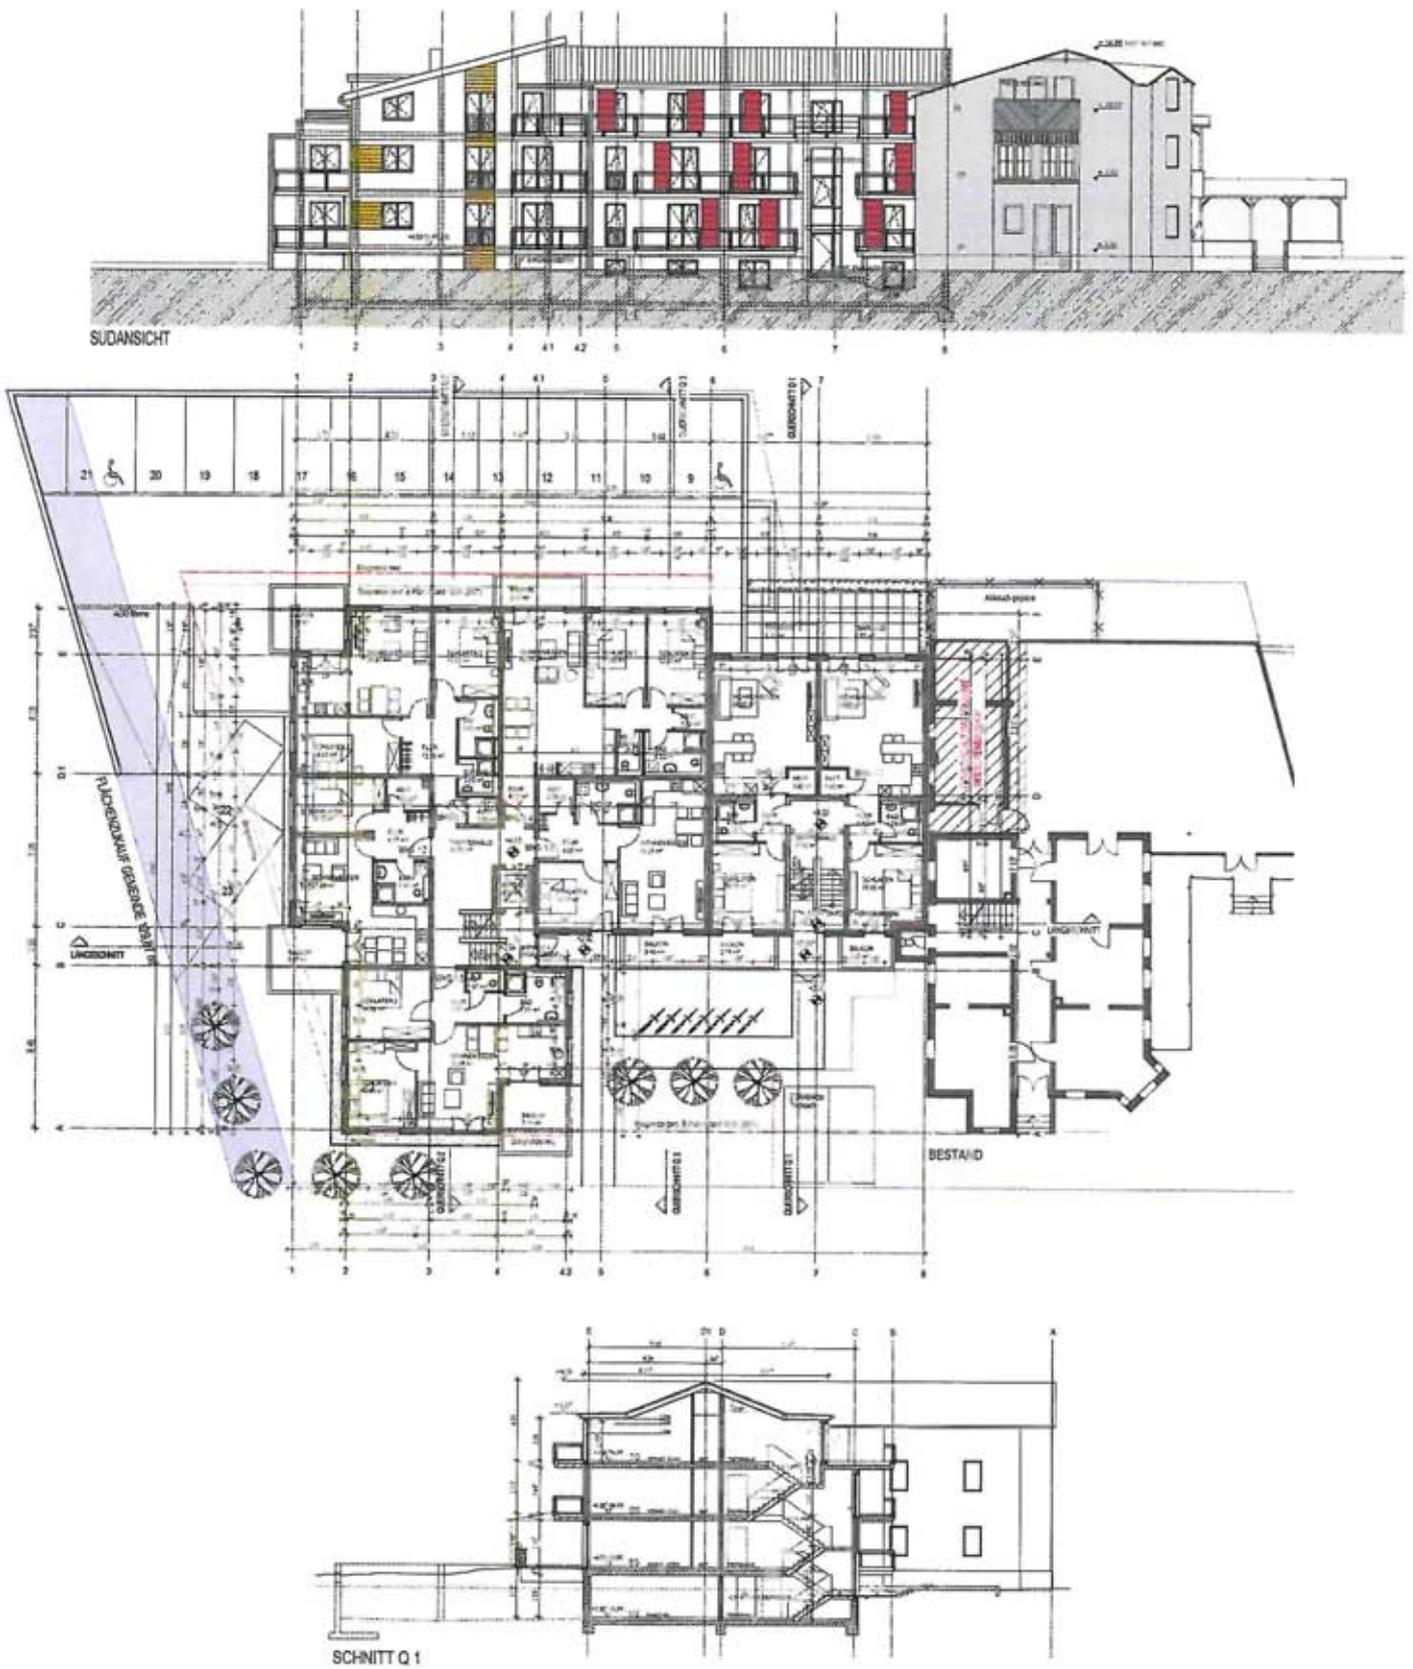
Ansicht von Süden, Erdgeschossgrundriss (und Schnitt Kruse Architekten, Stand 11.2011)
